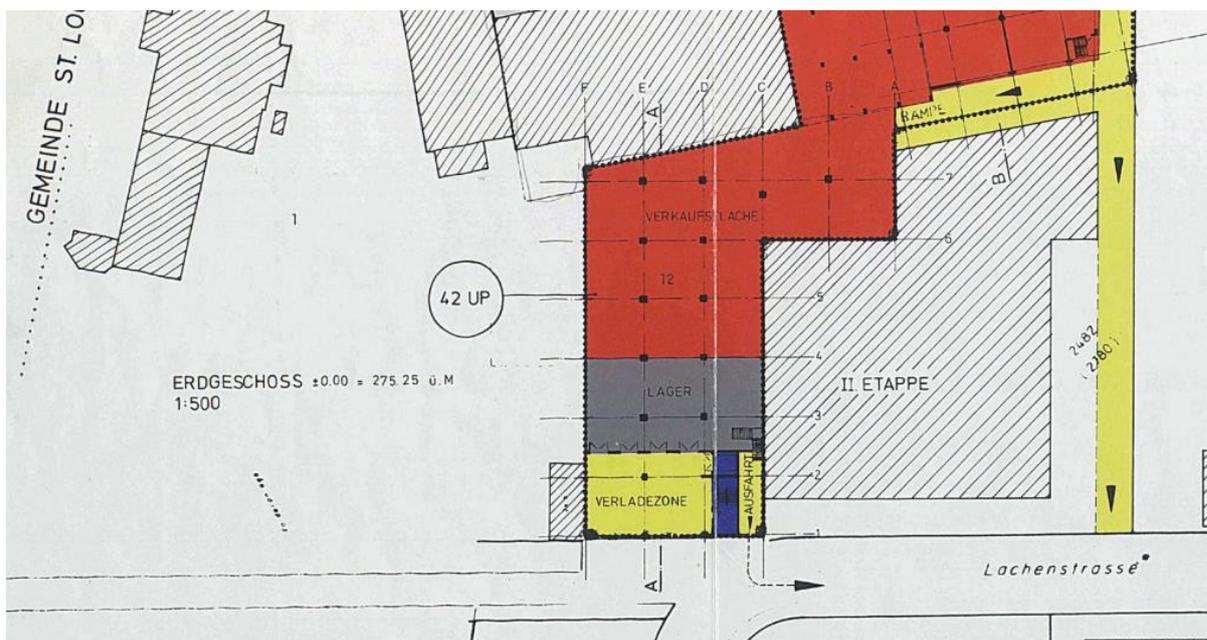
Ausschnitt aus dem Quartierplan «In den Lachen» (05.07.2024).
